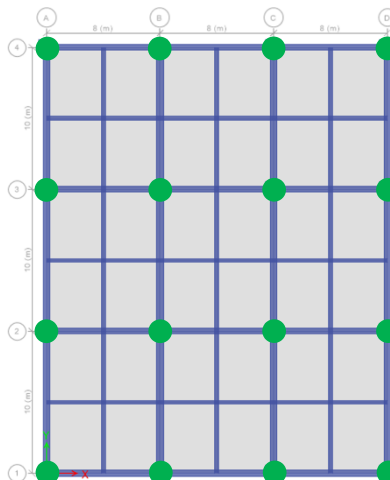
Configuración de los aisladores en la planta del edificio de 30 niveles
